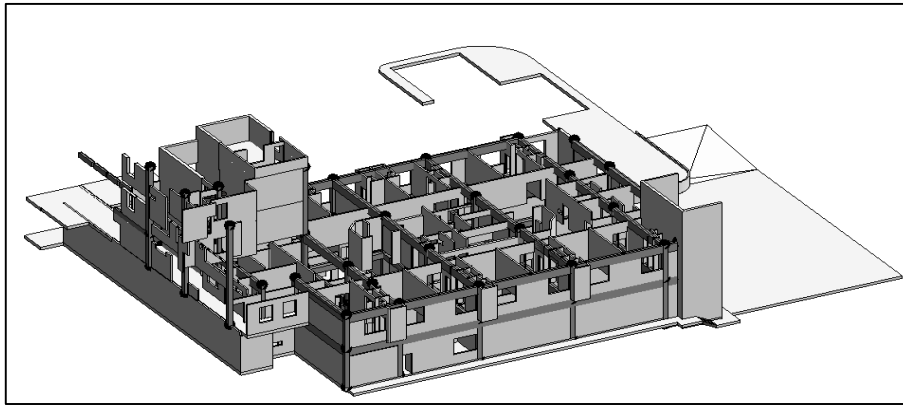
Inicio del levantamiento 3D de plano As- build a de AUTOCAD a REVIT del centro hospitalario.
